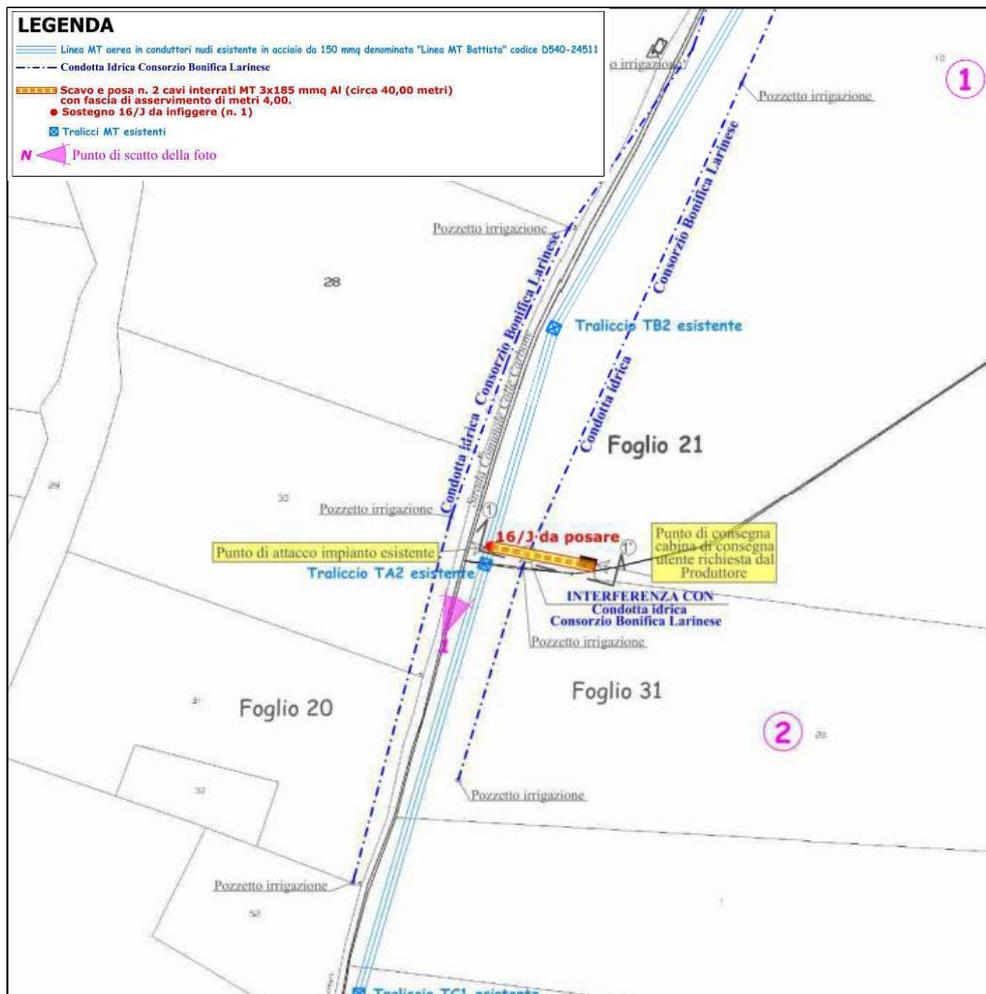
Stralcio planimetria interferenze opere di connessione - IMPIANTO NORD
